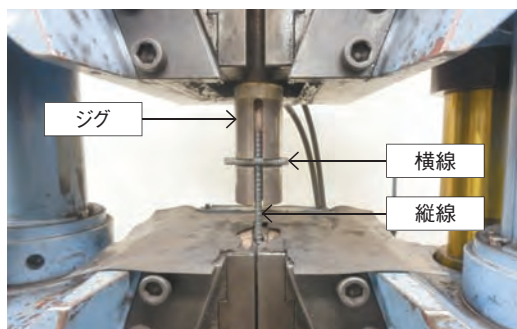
鉄筋格子の溶接点せん断強さ試験実施状況
